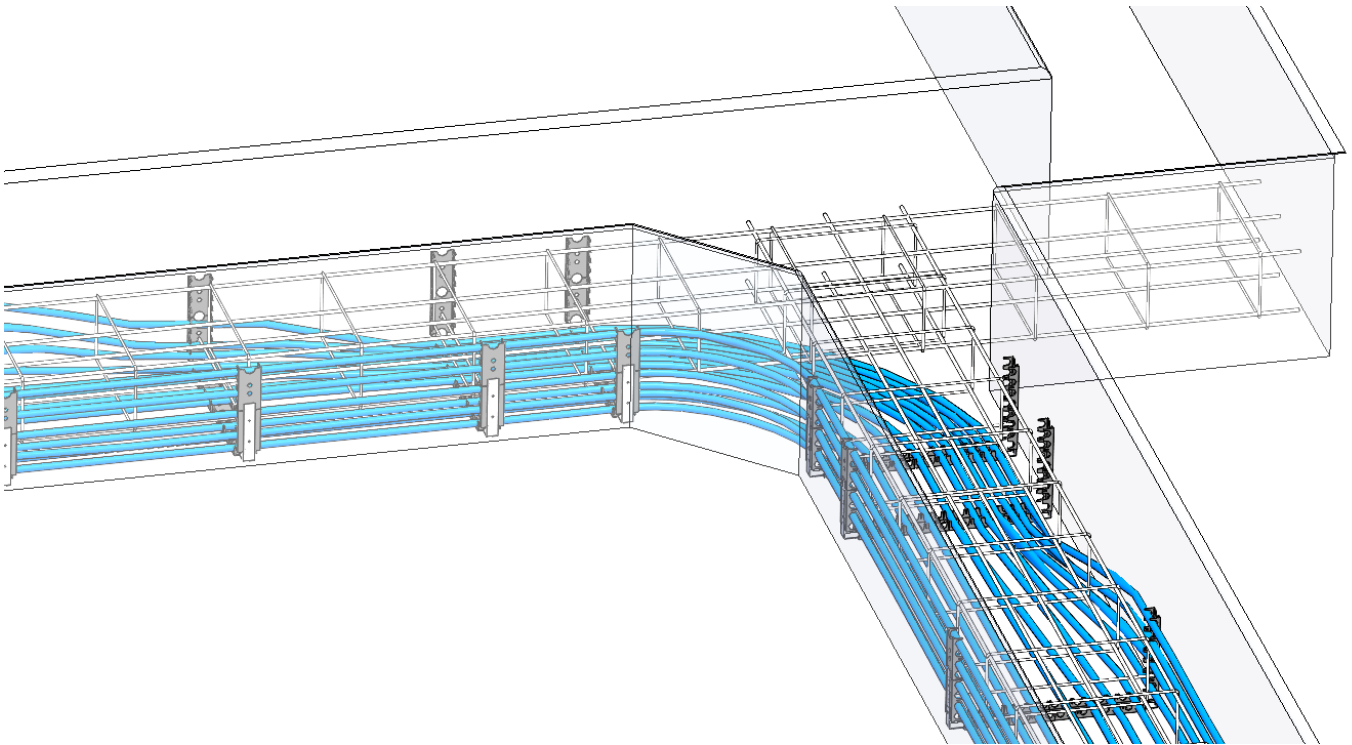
Disposition des berceaux et mise à plat des tubes en intersection de semelles
